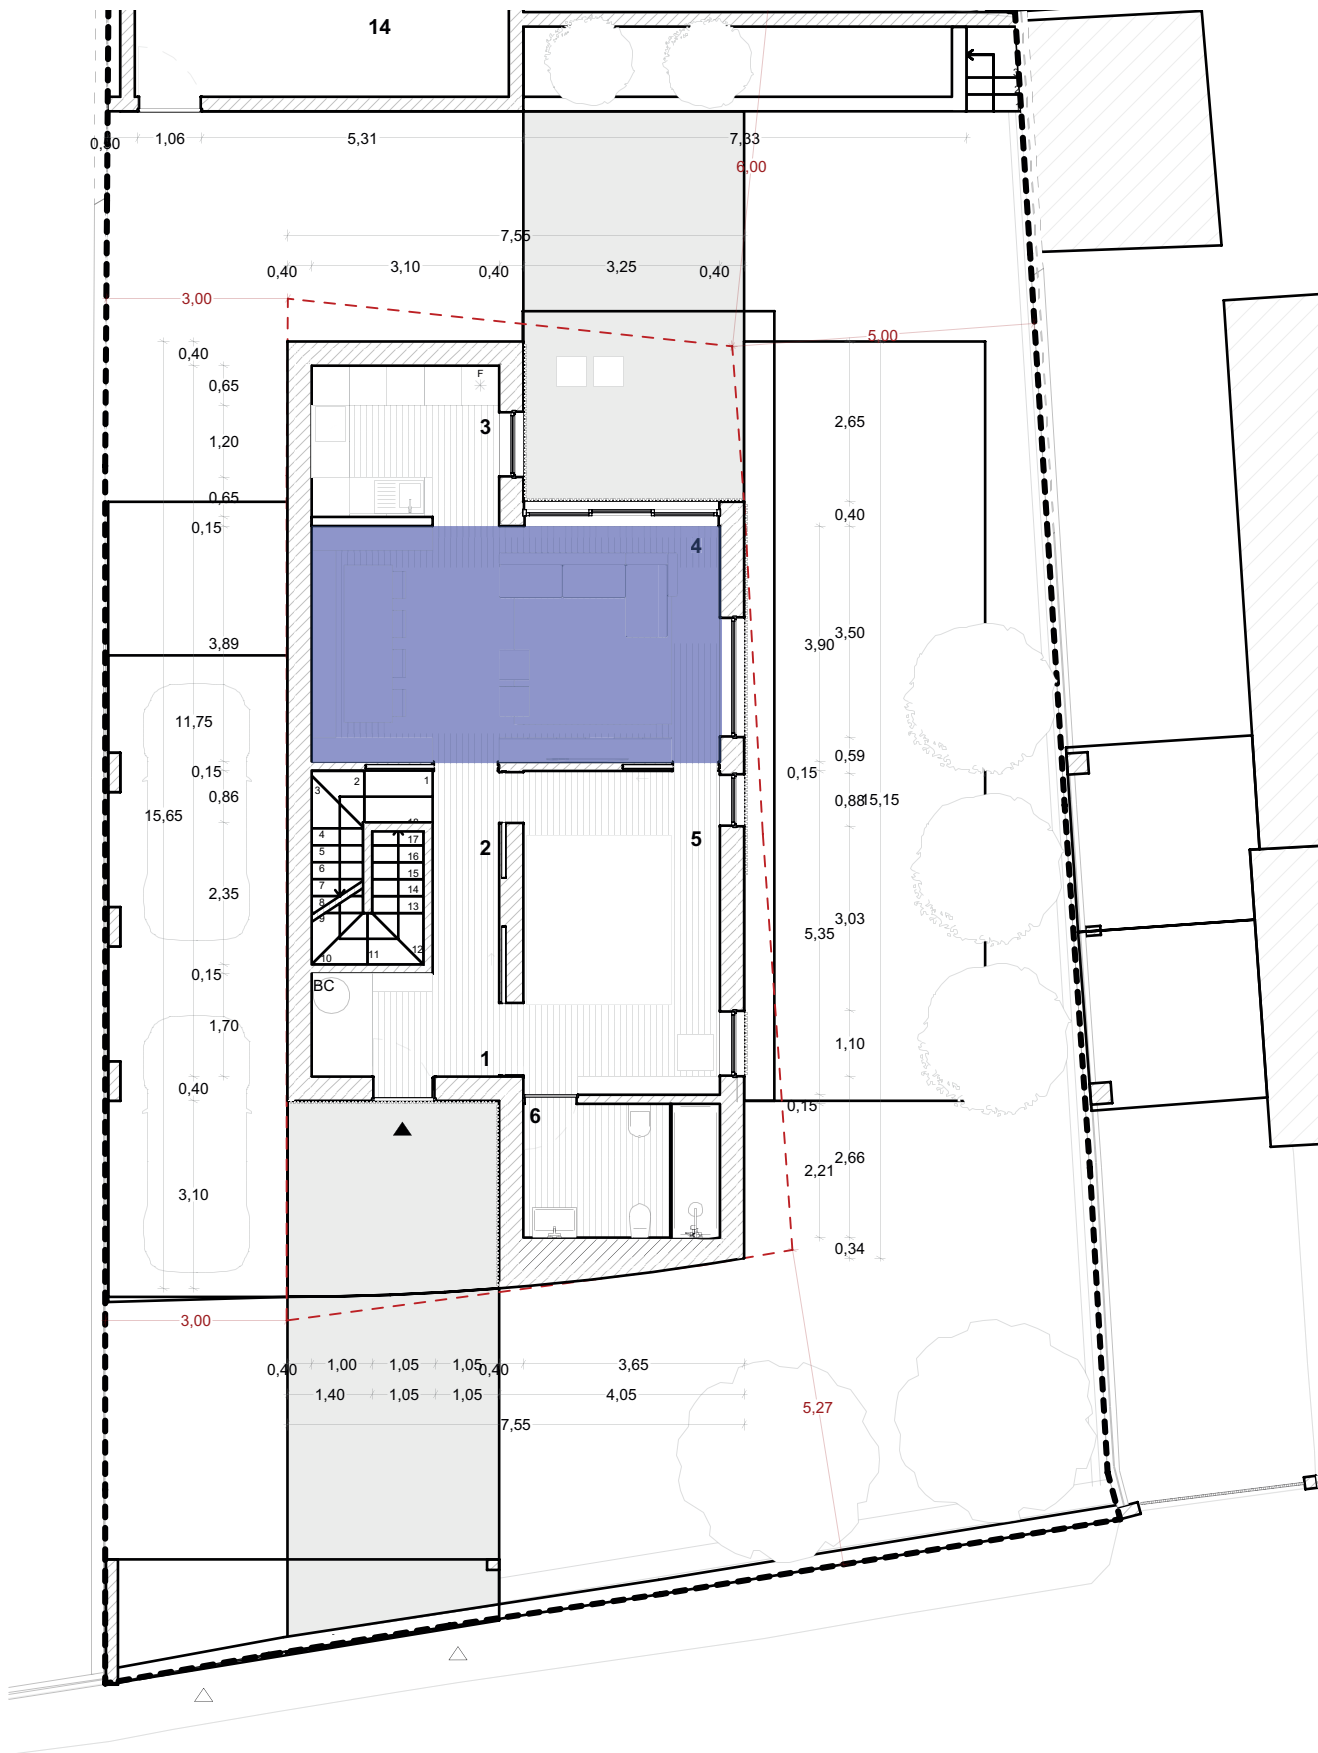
Planta piso rés/chão, identificação da divisão trabalhada.
